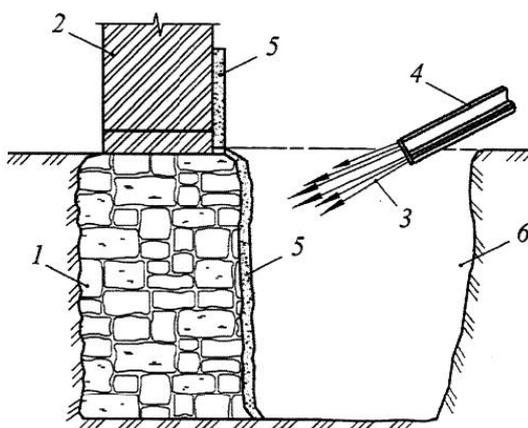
Закрепление кладки ленточных фундаментов: 1 – существующий фундамент, имеющий расслоение бутовой кладки; 2 – набрызг бетонной смеси под высоким давлением; 3 – торкретированная поверхность фундамента; 4 – торкрет-машина для набрызга бетонной смеси; 5 – кирпичная стена; 6 – вскрытая пазуха фундамента
